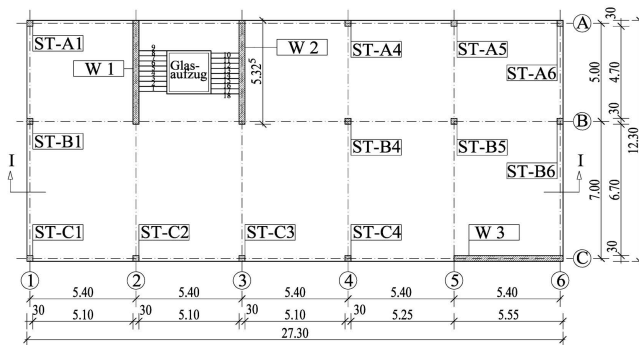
Grundriss im Regelgeschoss
